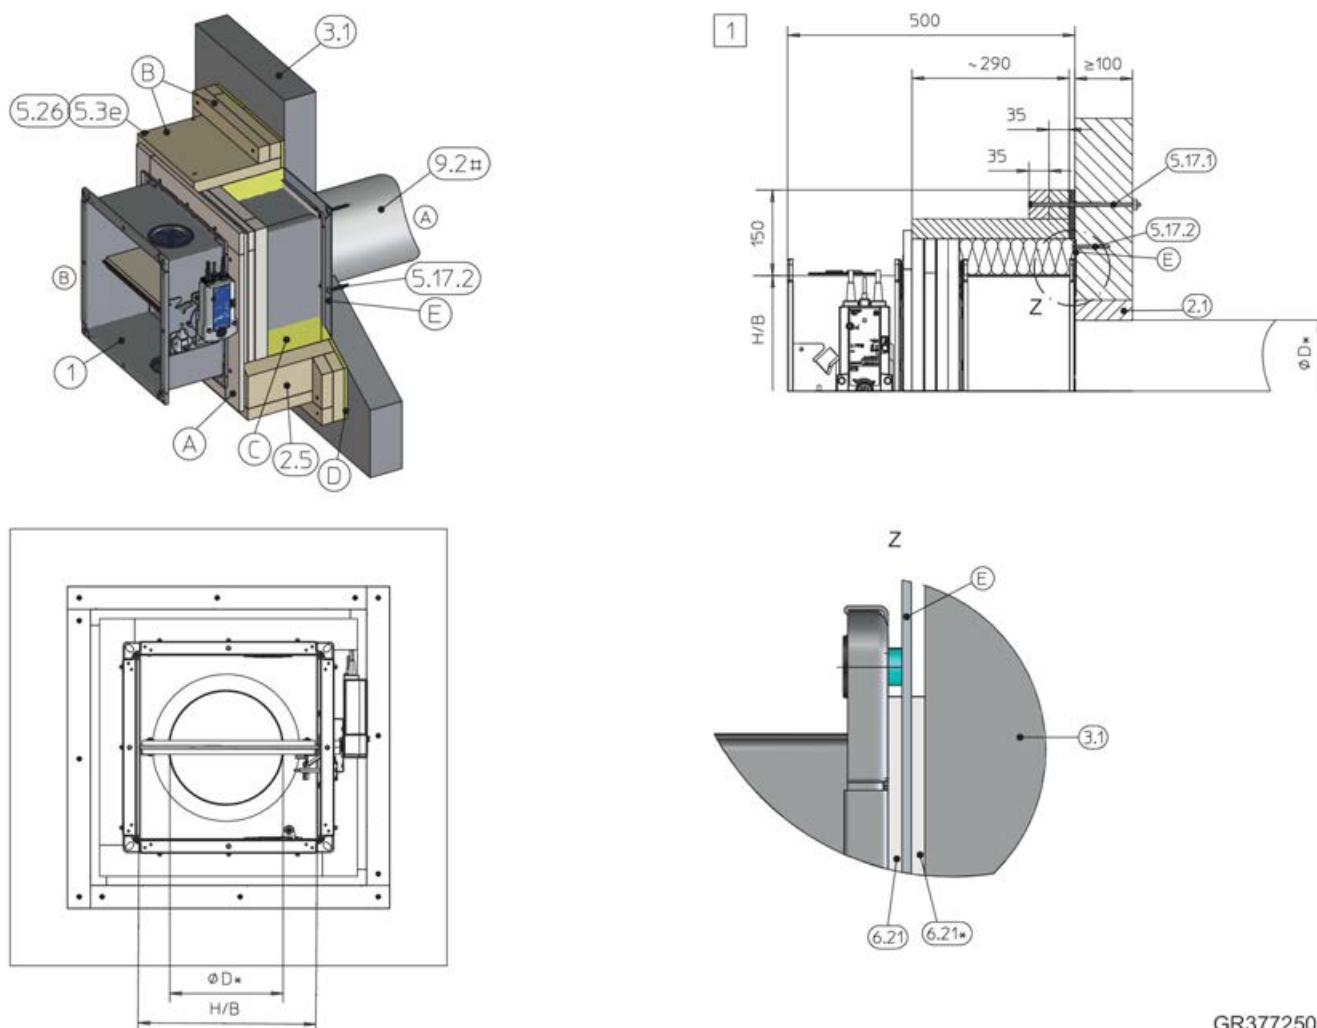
Installazione a secco su una parete piena (raffigurazione di parete in calcestruzzo) con kit d'installazione WA (applicazione su parete e condotto fissato con malta)
